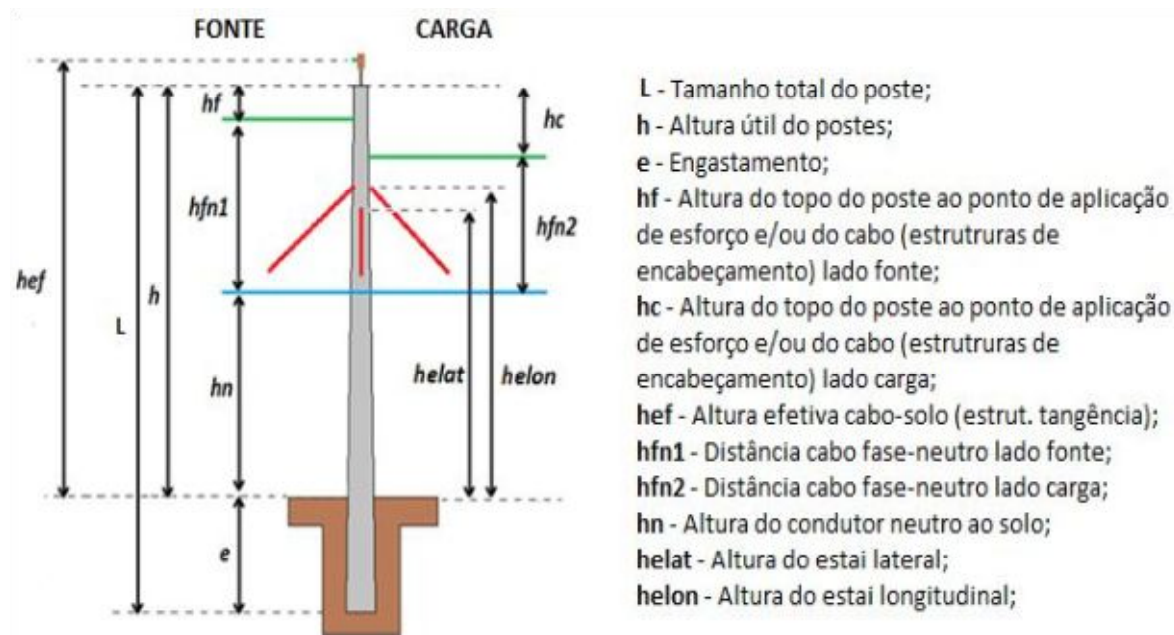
Detalhe de Instalação da Estrutura U3U3. Fonte: Própria Autoria.
